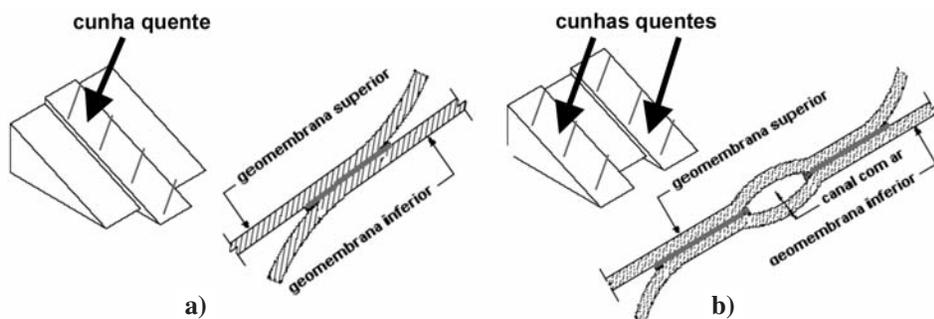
Soldaduras simples (a) e duplas (b) por termofusão (adaptado de Steel Dragon Enterprise CO).
